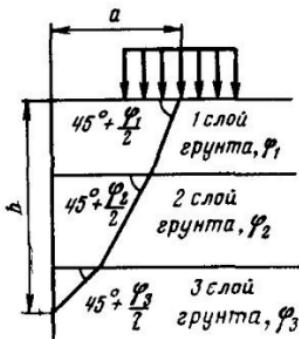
Схема для определения эквивалентной нагрузки при наличии за стенкой нескольких слоев грунта, отличающихся углами внутреннего трения
